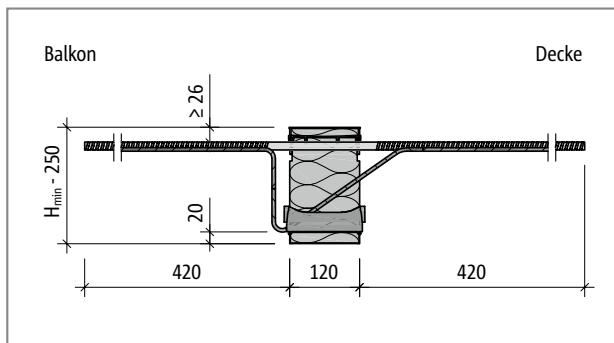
Schöck Isokorb® CXT Typ K-M6 bei R0: Produktschnitt
